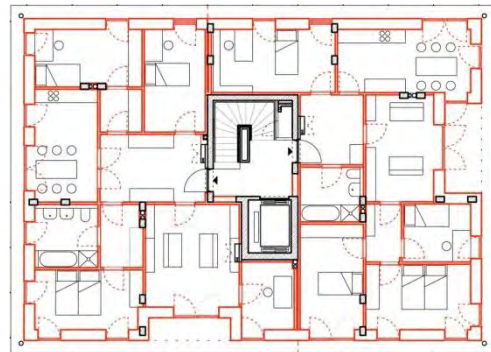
Segunda fase de la Grundbau und Siedler. Diseño de las viviendas llevado a cabo por los ocupantes mediante autoconstrucción, 2013
